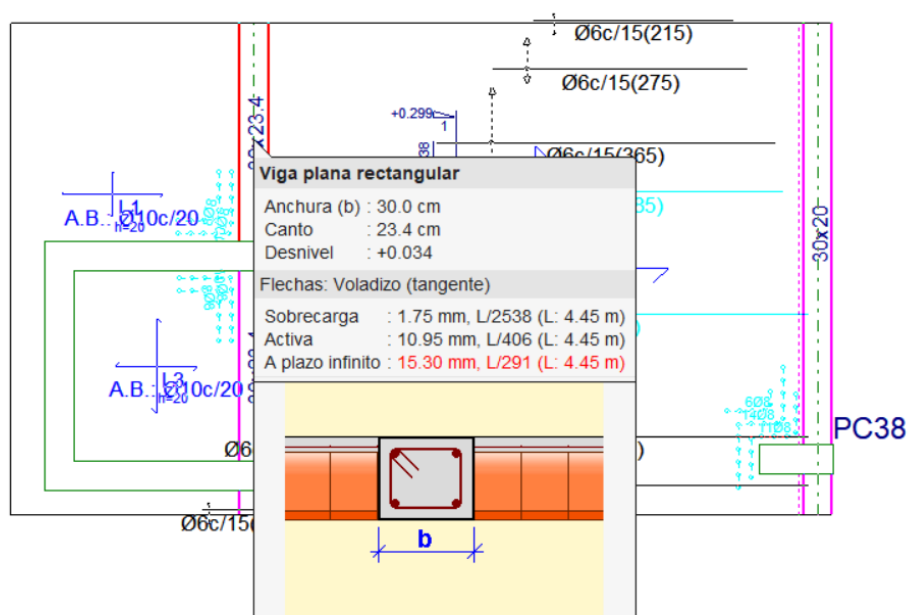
Flechas en Vigas, Planta Castillete, Modulo C
